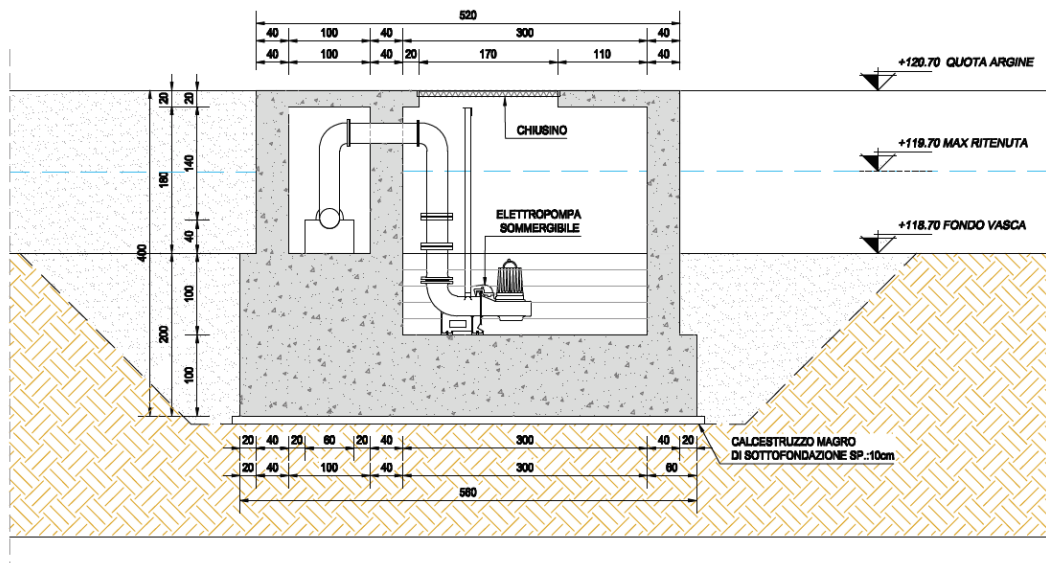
Sezione trasversale impianto di sollevamento
